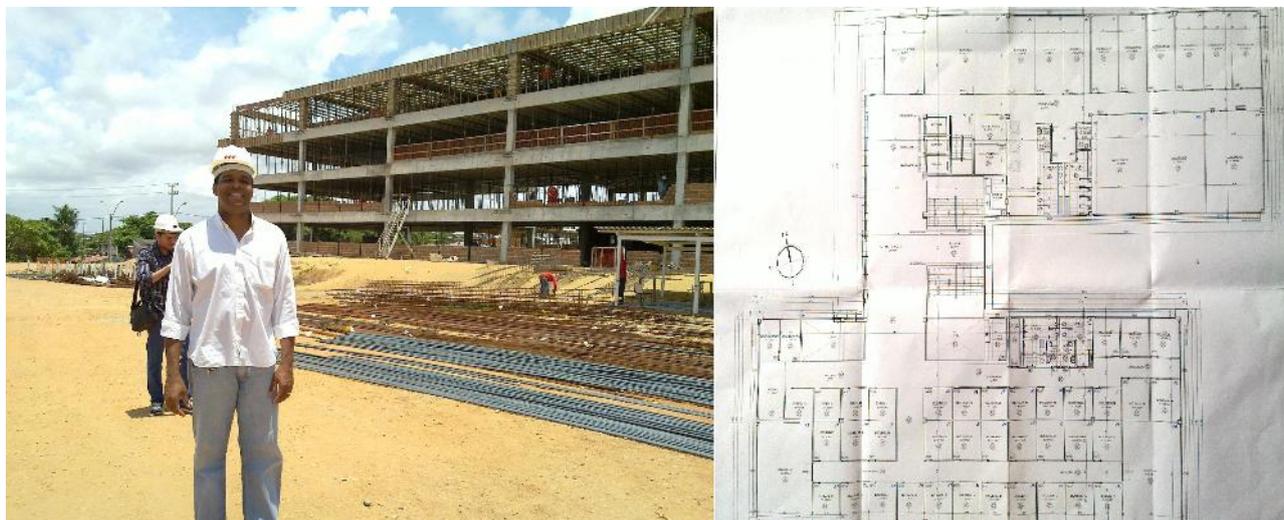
Visitando o canteiro de obras do CIVT, principal prédio integrante do Instituto MetrÓpole Digital, e a planta baixa do 3º andar. (Outubro de 2011)
